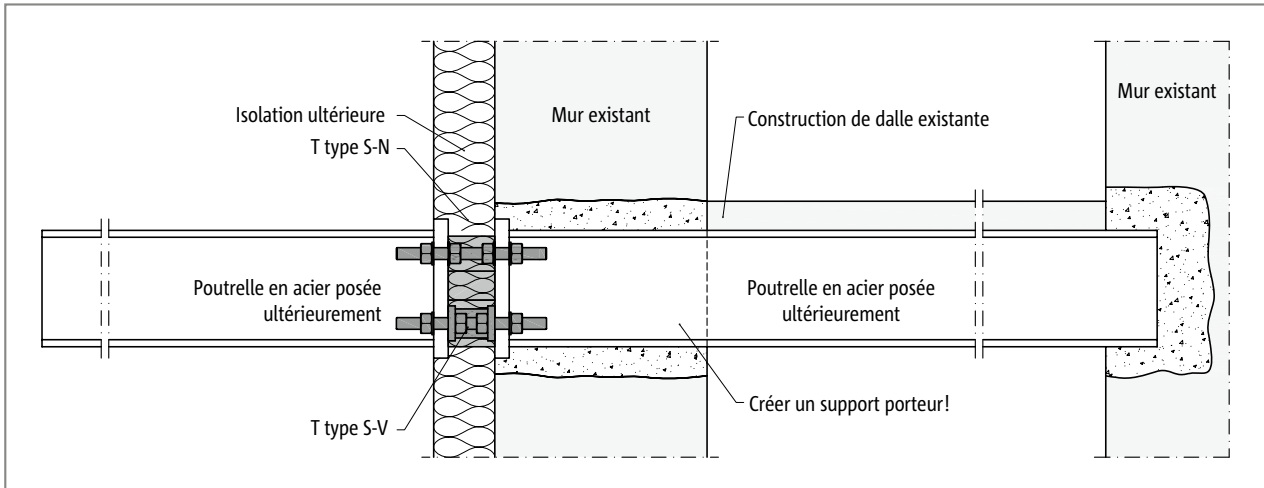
Schöck Isokorb® T type S-N et T type S-V : balcon en acier en porte-à-faux libre posé ultérieurement ; raccordé à des poutres en acier installées ultérieurement
